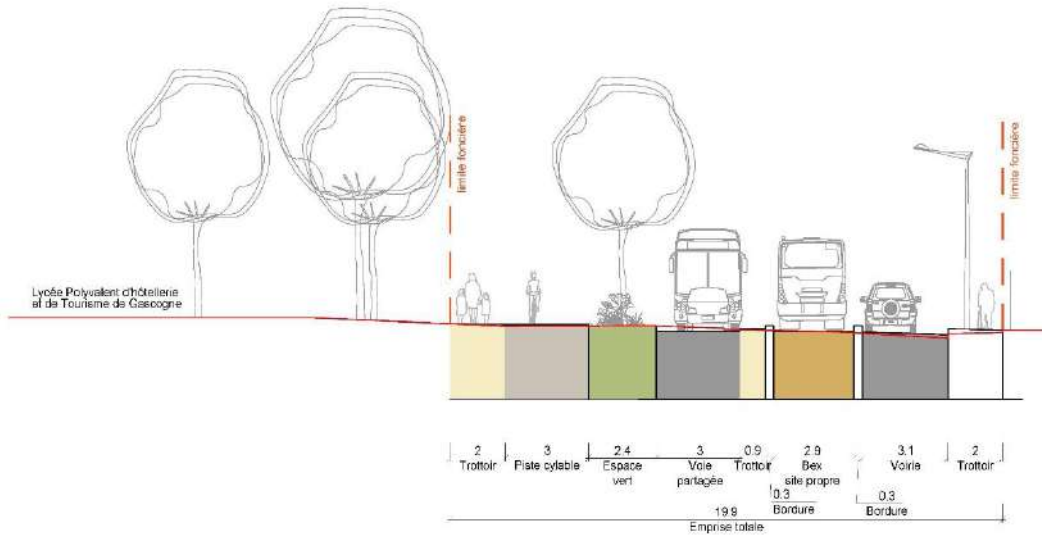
Coupe type sur l’avenue de Thouars Nord
